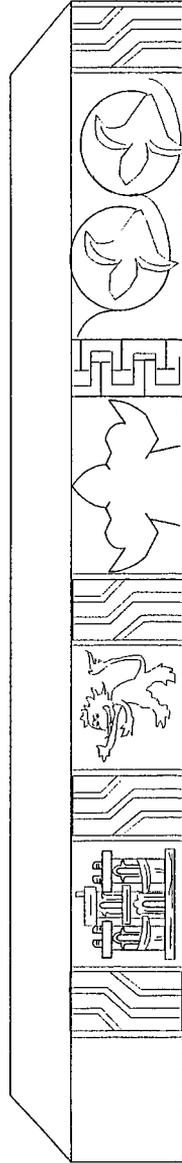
Croquis aproximado de la viga reutilizada para el armado posterior
